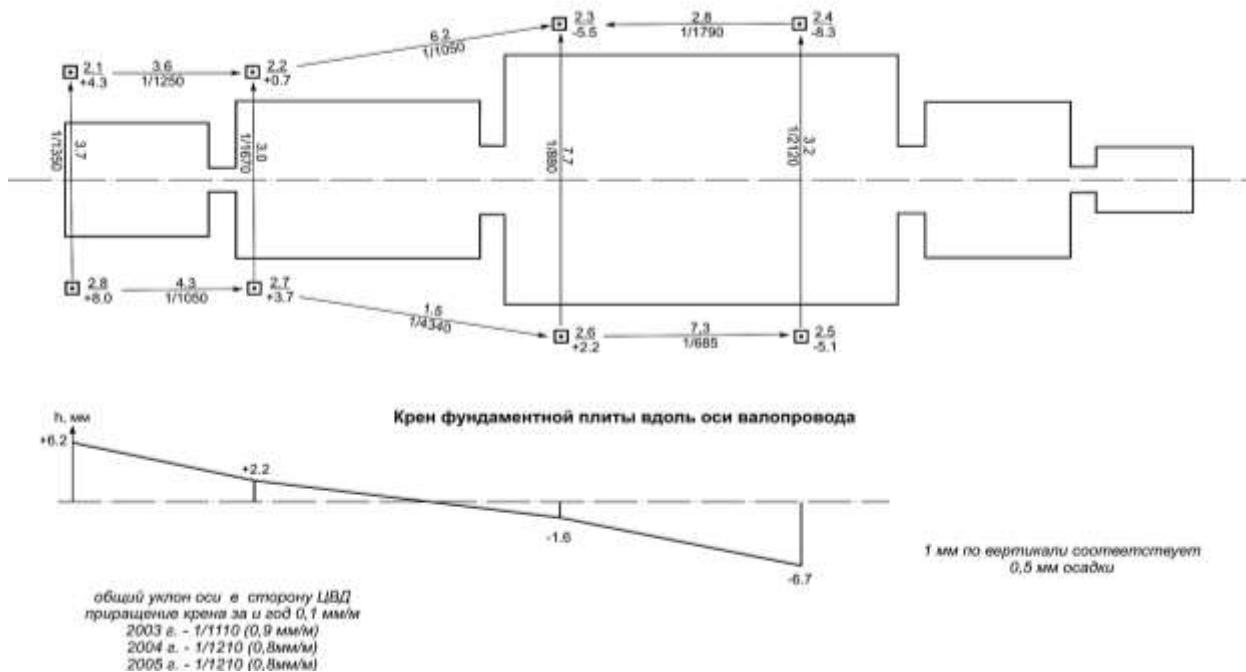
Схема продольных и поперечных кренов верхней фундаментной плиты турбоагрегата
